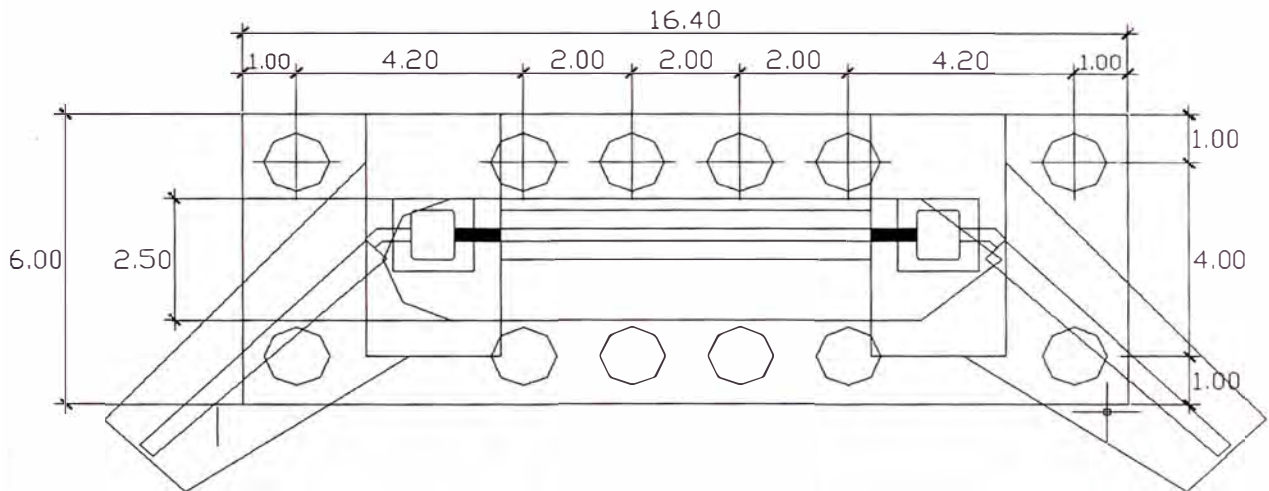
Vista en Planta de la Cimentación Profunda.
